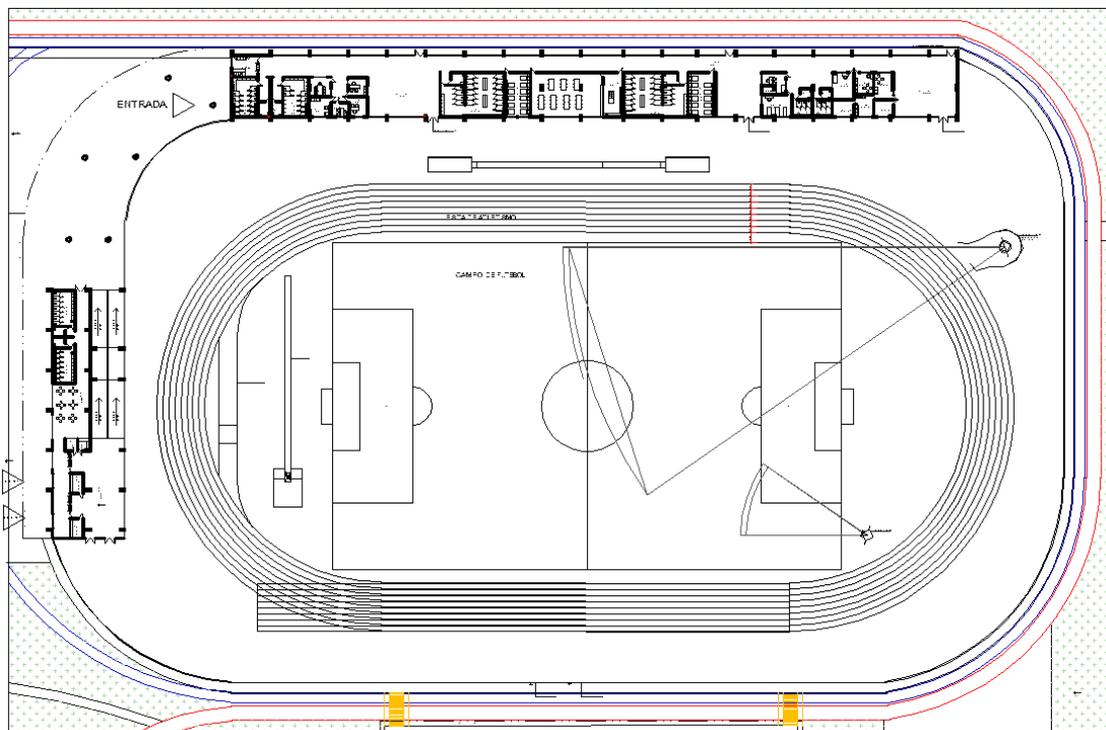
Planta baixa bloco 02. Fonte: Produção própria.
